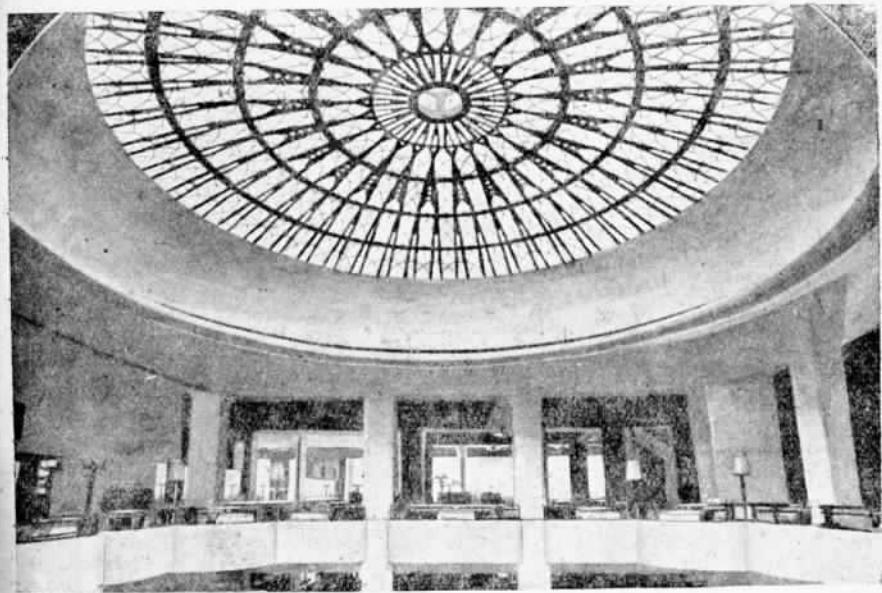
Вид мозаичного стекло-железобетонного перекрытия
